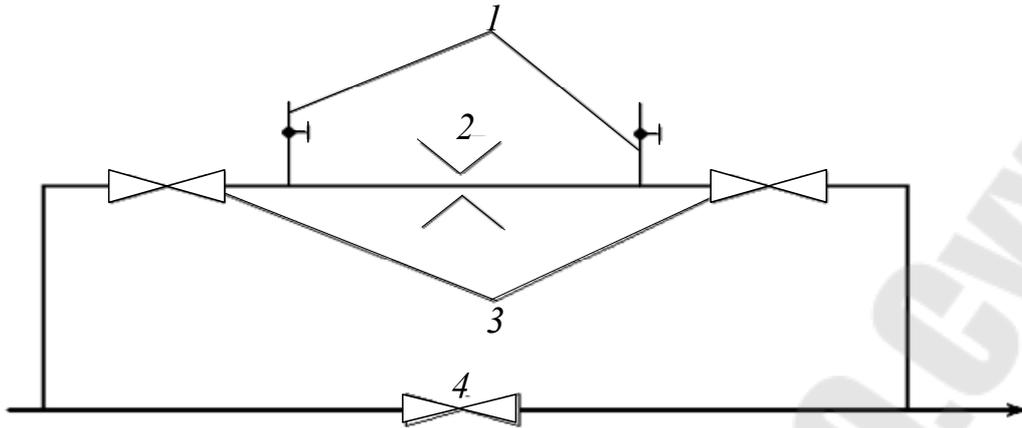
Схема байпаса для установки дроссельной диафрагмы на трубопроводе тепловой сети:
